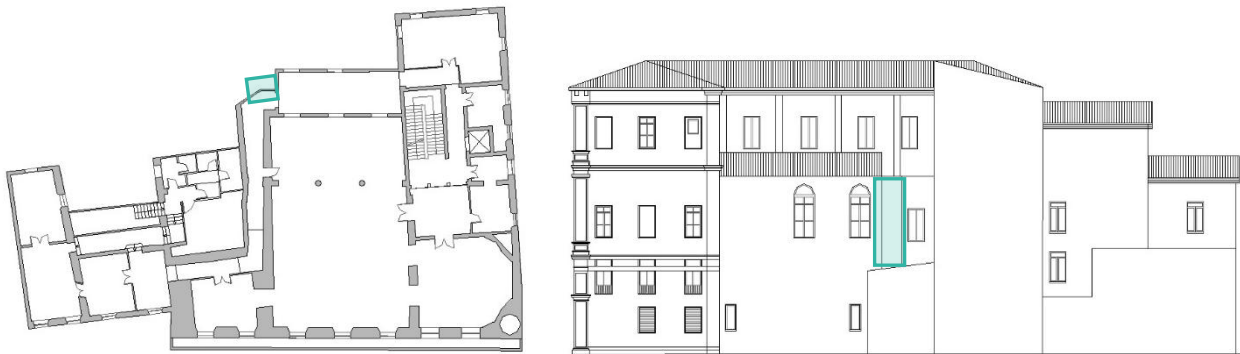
Individuazione macroelemento, pianta e prospetto
